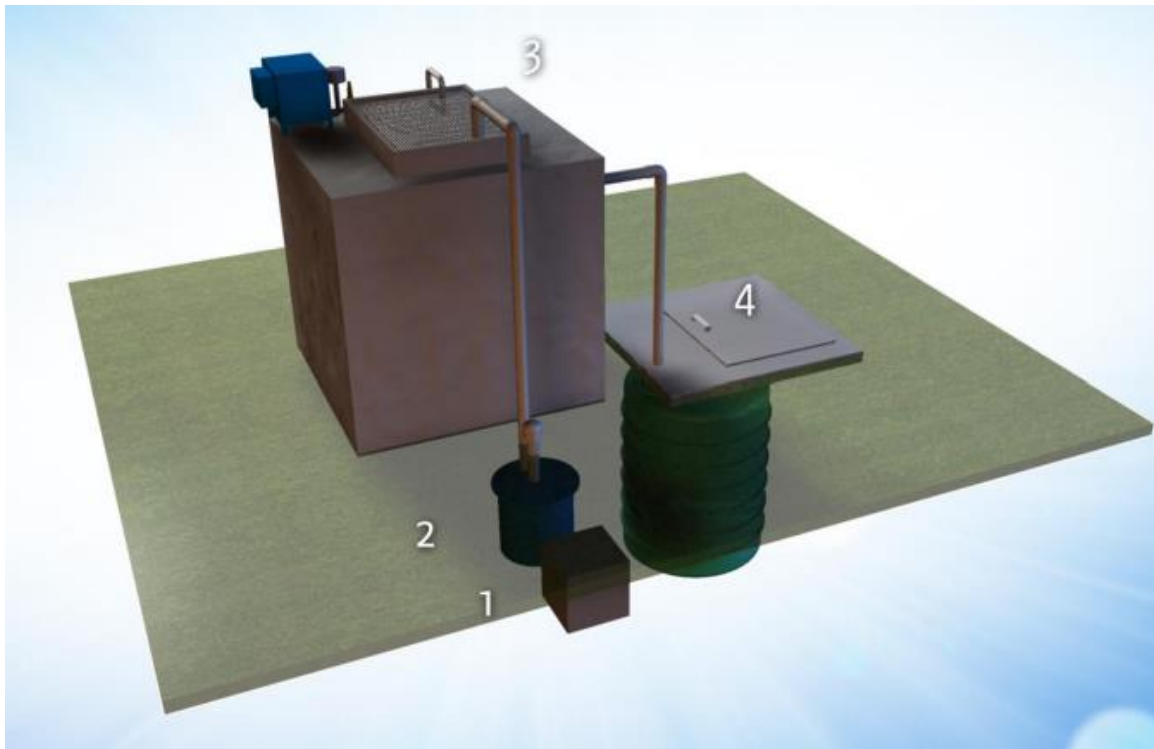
Esquema del arreglo modular de la planta de tratamiento.
